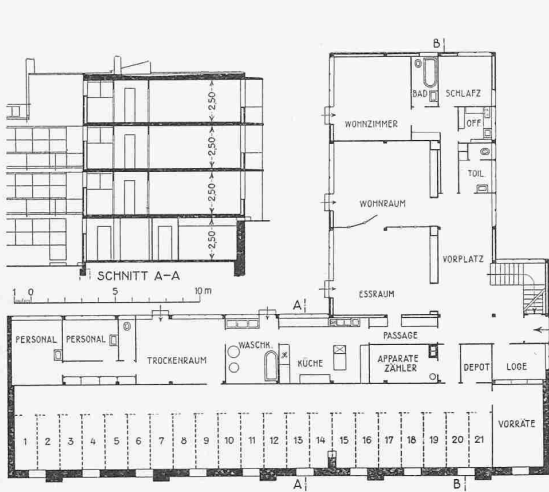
bis 4. Grundrisse, links Untergeschoss, rechts Erdgeschoss und Schnitte. Masstab 1 : 400.
